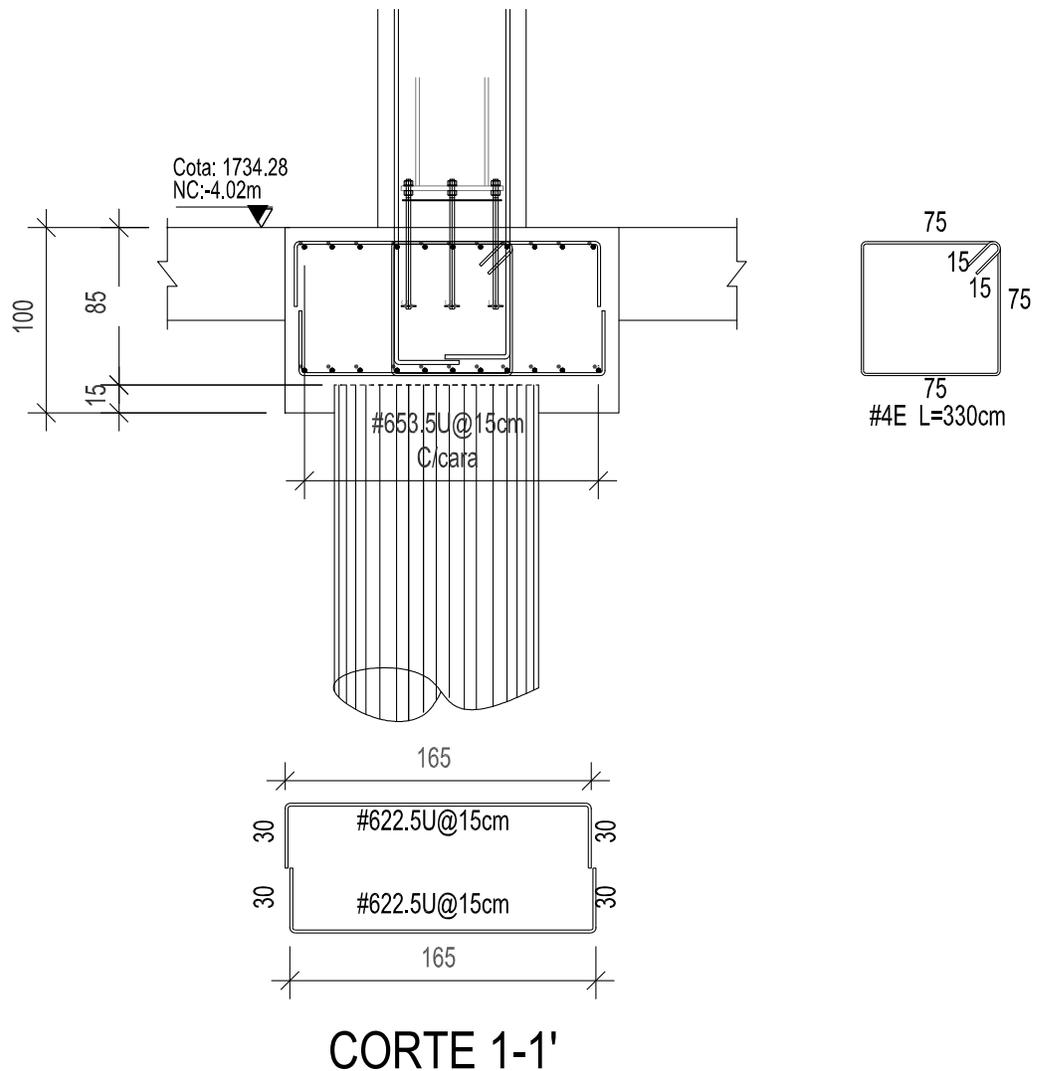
Vista en planta y perfil del cabezal de pilote. (Dado de cimentación) (Fuente: Departamento de diseño Metálicas e Ingeniería S.A.)
